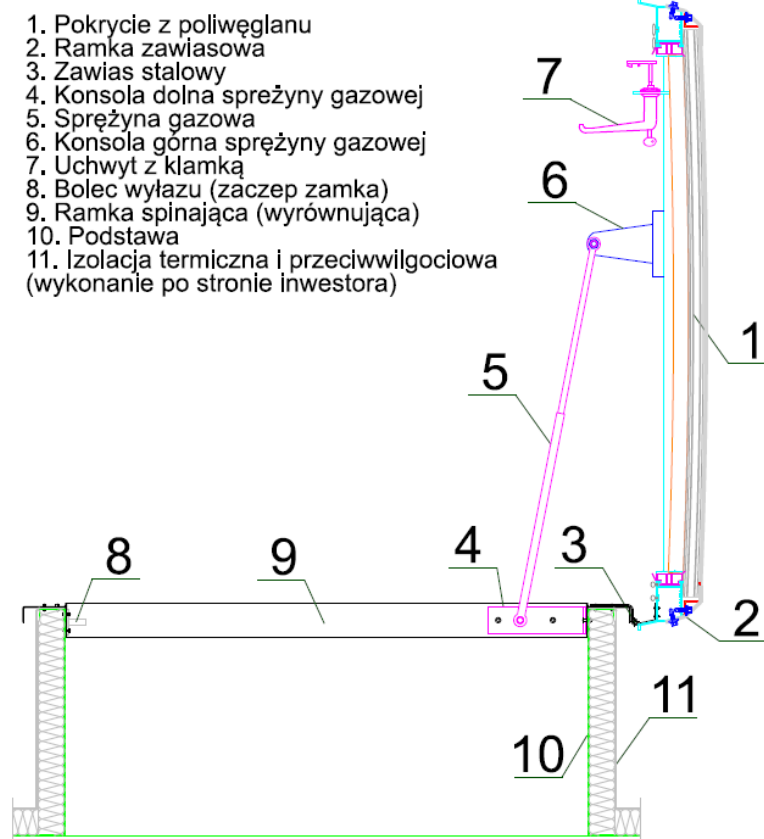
Przekrój przez konstrukcję wylazu dachowego, podstawa z blachy stalowej
